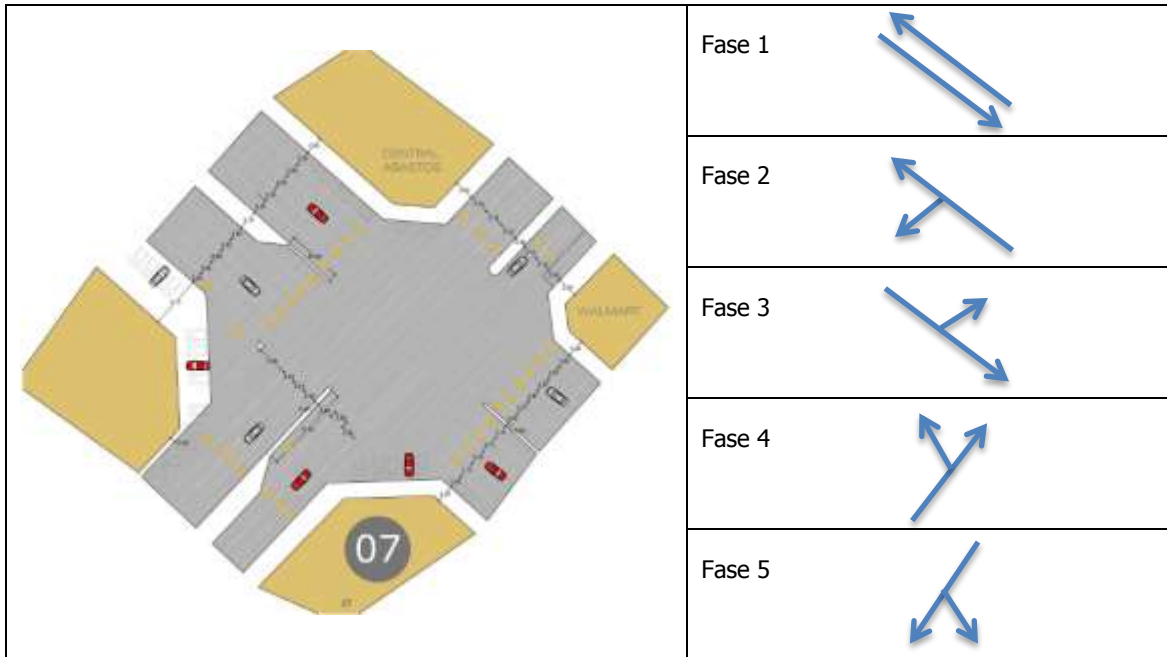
Par vial Calzada Abastos-Calzada de las Palmas
